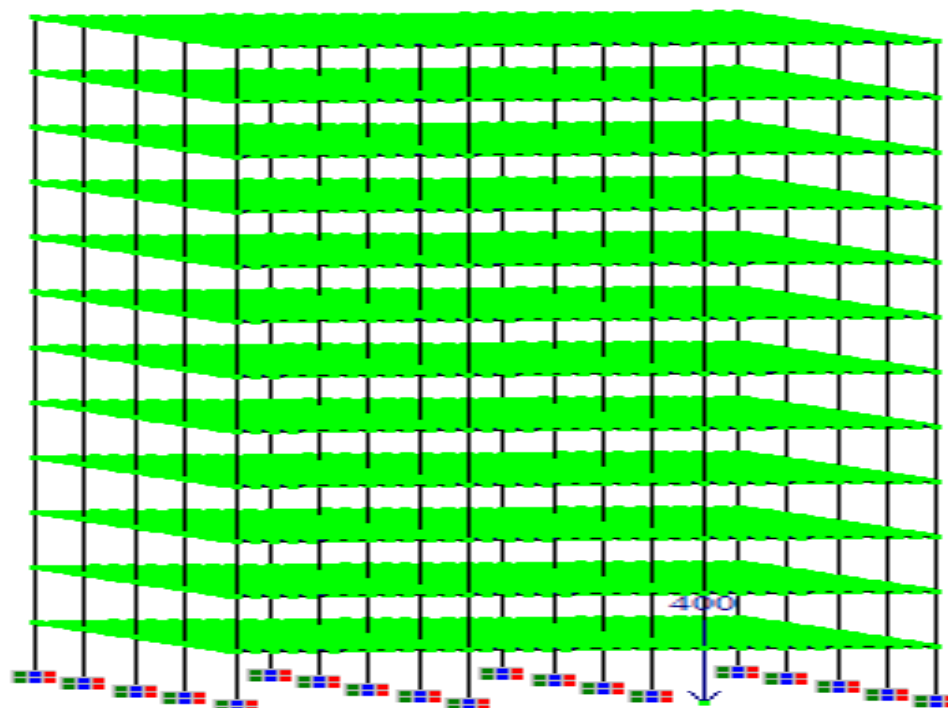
Schéma illustratif du modèle d'étude du bâtiment avec planchers en hourdis à 12 niveaux avec un chargement vertical sur le poteau de rive
